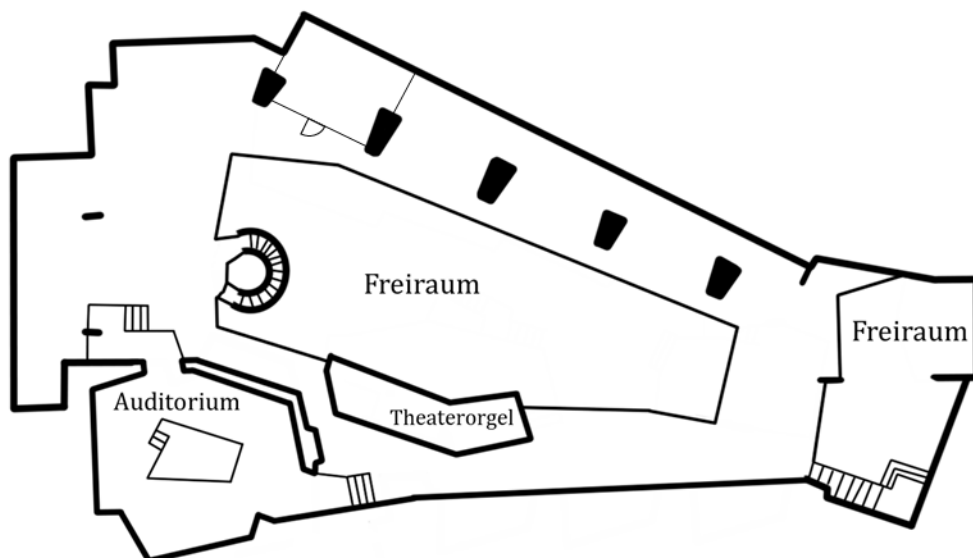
Grundriss des Berliner Musikinstrumenten-Museums, 1. Stock (Galerie)
